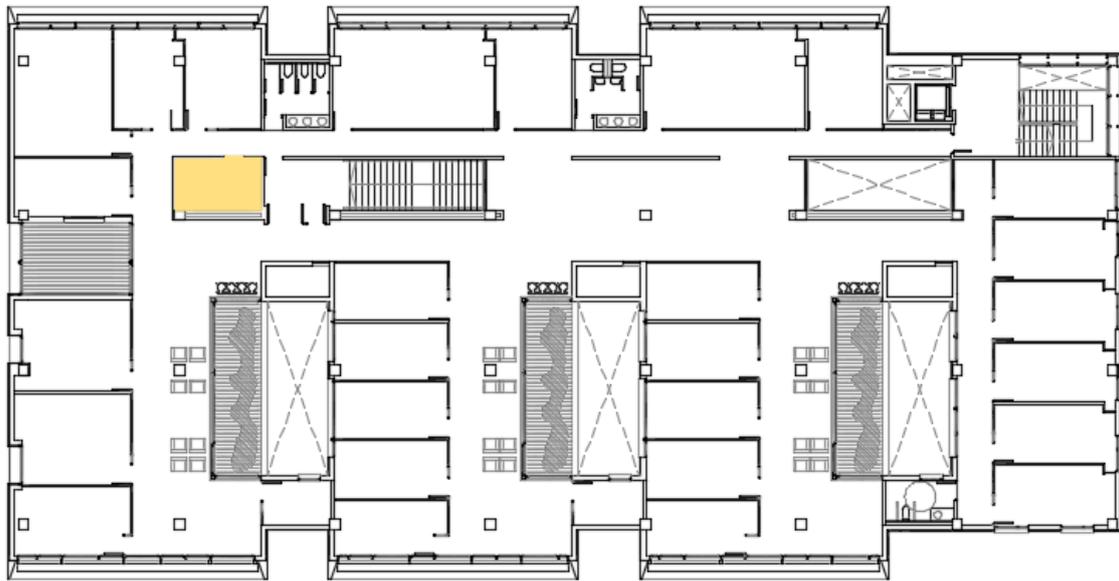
Situación RACK en Planta Tercera. Figura extraída del plano 55.
